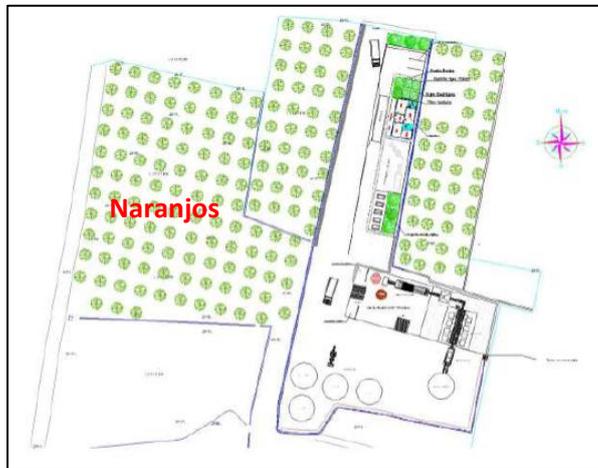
Plano de la planta de RCDs. Fuente: Proyecto de planta de tratamiento de Residuos de construcción y Demolición en Algemés (Valencia).
